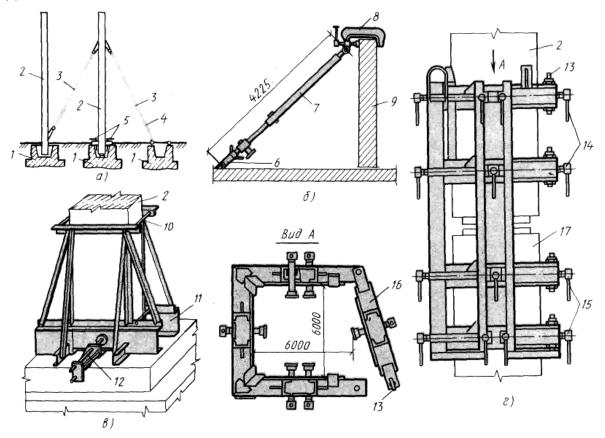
Приспособления для временного закрепления и выверки конструкций:
